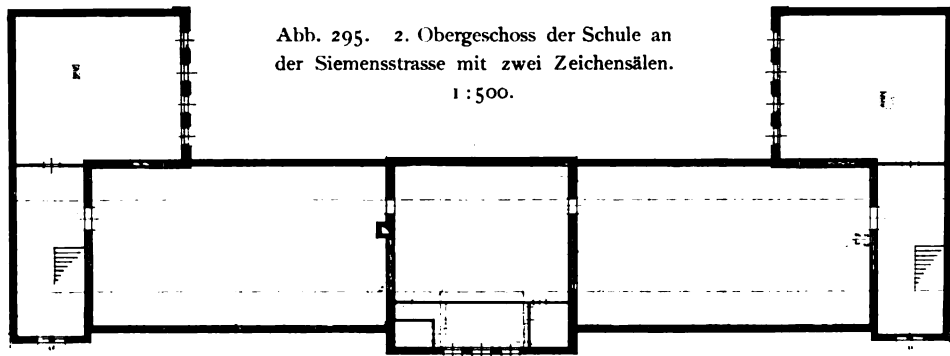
2. Obergeschoss der Schule an der Siemensstrasse mit zwei Zeichensälen.
